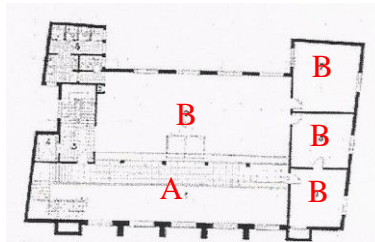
Planta baixa 1º pavimento, ag. Niterói-RJ, 1940 (Fonte: Ströher, 1999).
